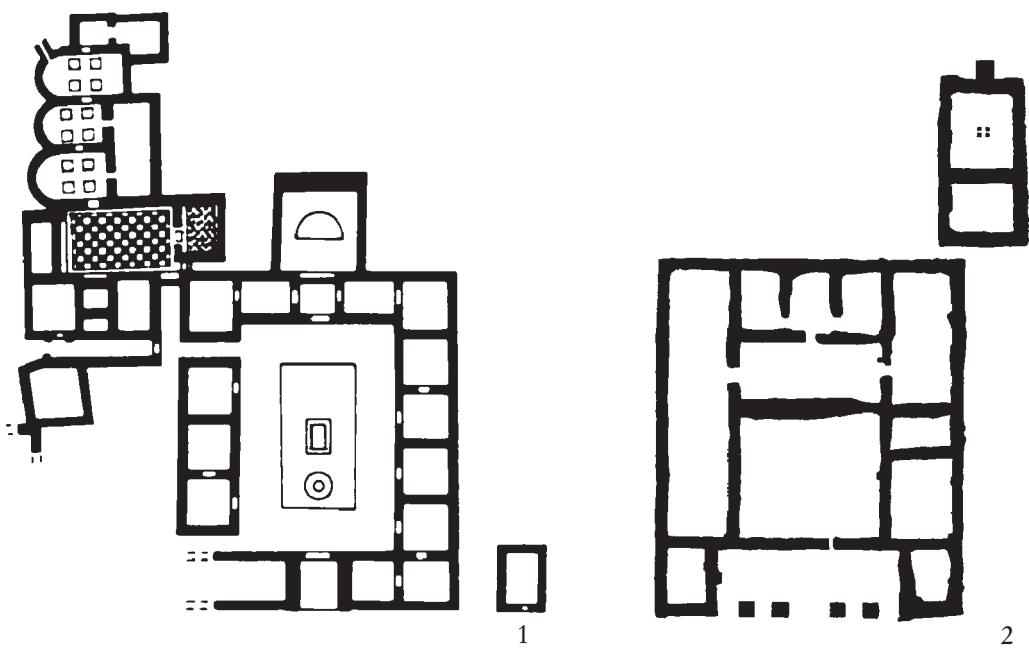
Größen- und Grundrissvergleich der Straßenpraetoria von 1 Muru de Bangius (Sardinien, I) und 2 Oedenburg-Westergass (Haut-Rhin, F). – M. 1:600.
